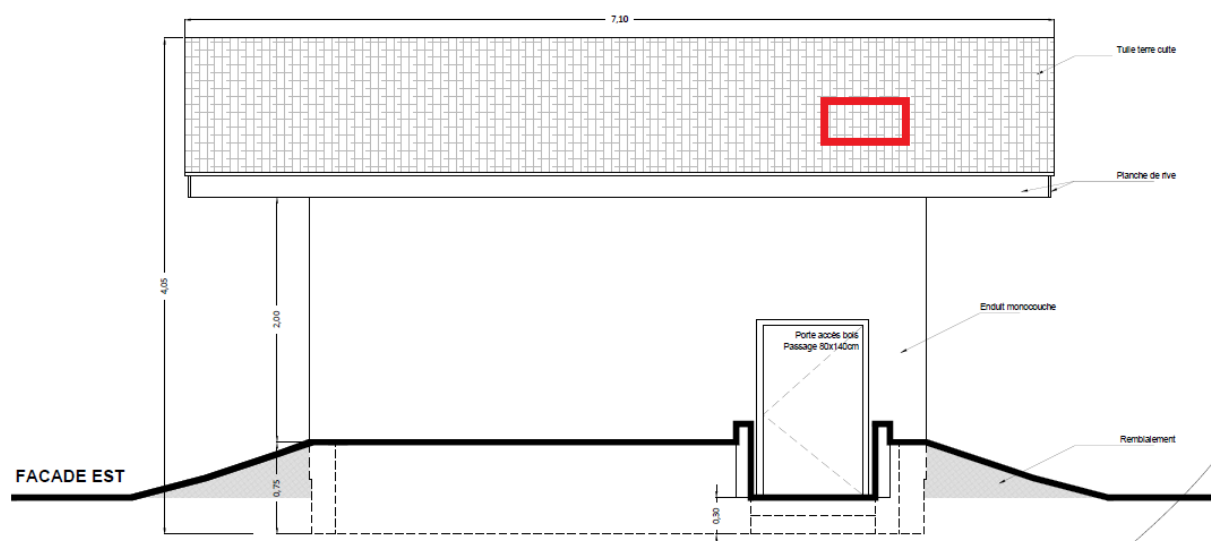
Zone d'implantation du nichoir artificiel sur la façade est (emprise rouge)
